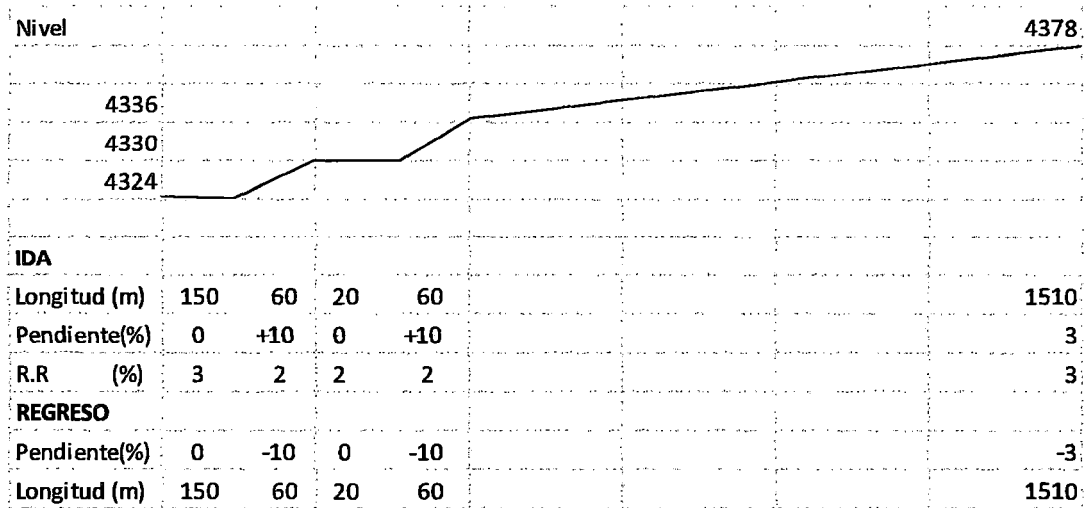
Alzado del perfil de transporte ruta N° 03
